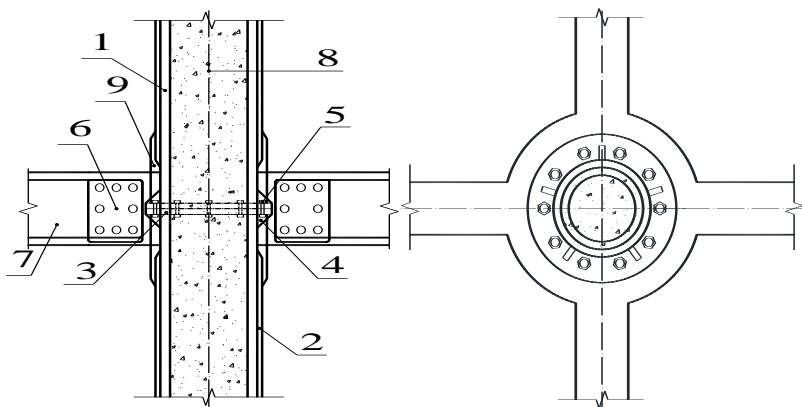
法兰连接钢筋混凝土梁节点
